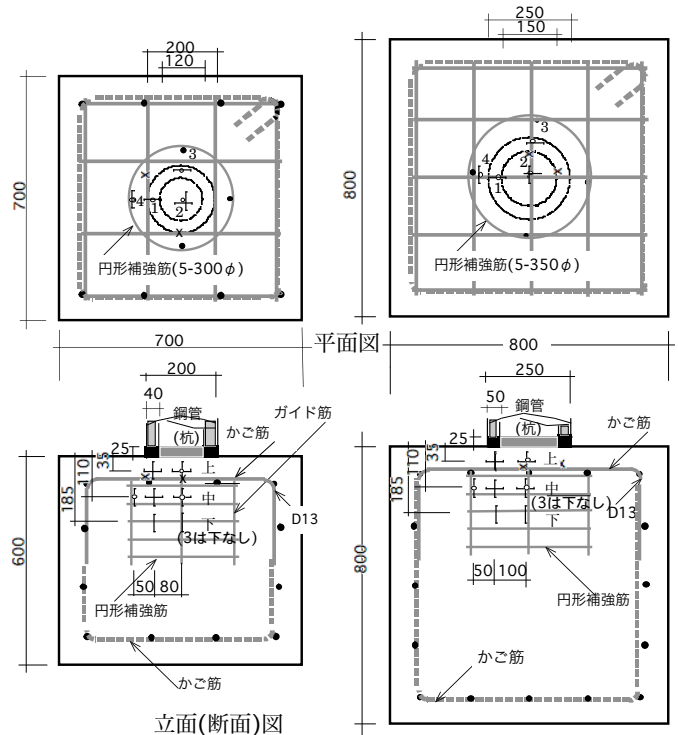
供試体平面図と断面図(左: 杭径200, 右: 杭径250)
